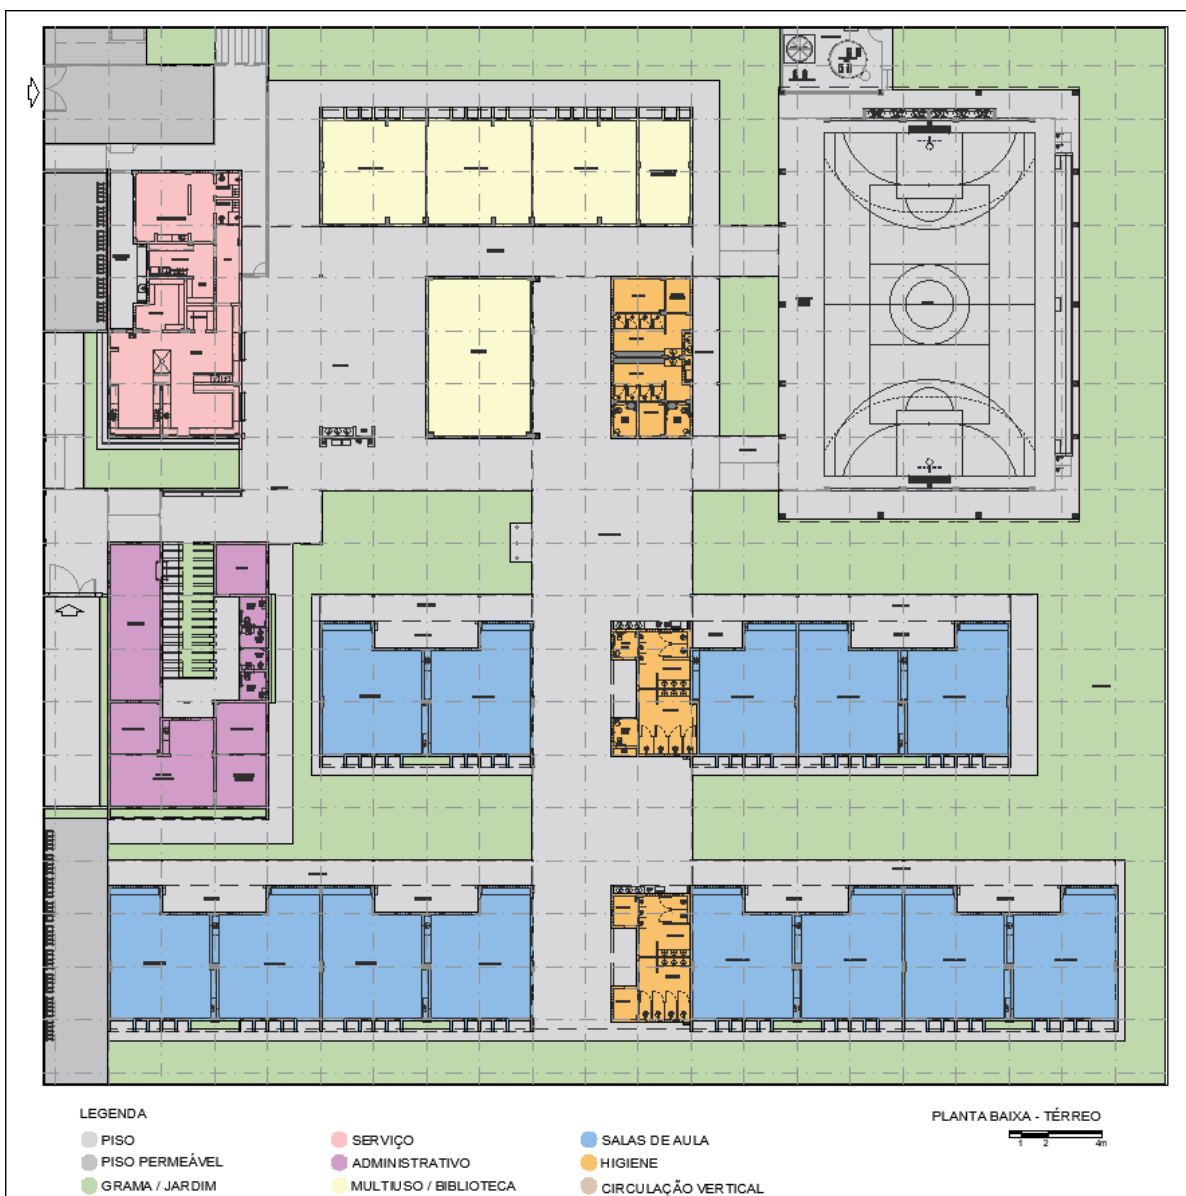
planta baixa de implantação dos blocos – Escola 13 Salas - Térreo
